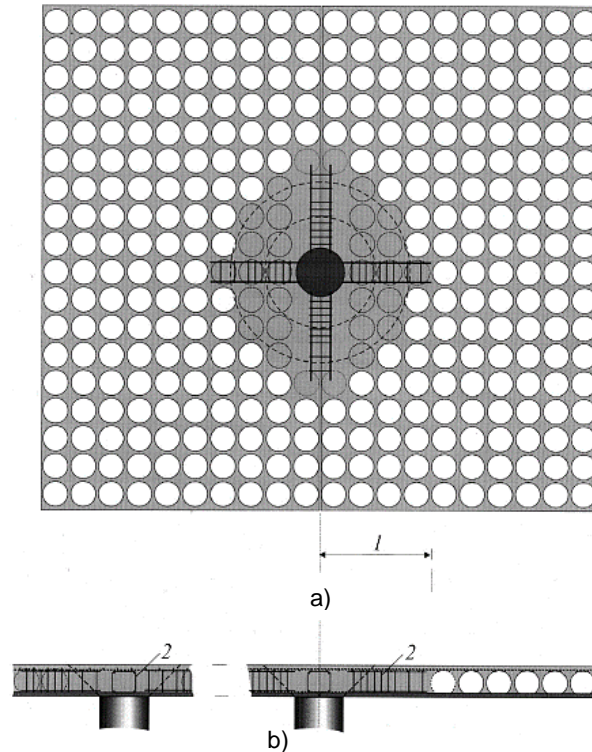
a) Projeção da área sem esferas sobre pilar; b) Armadura de reforço ao cisalhamento (CALIN E ASAVOAIE, 2009).
